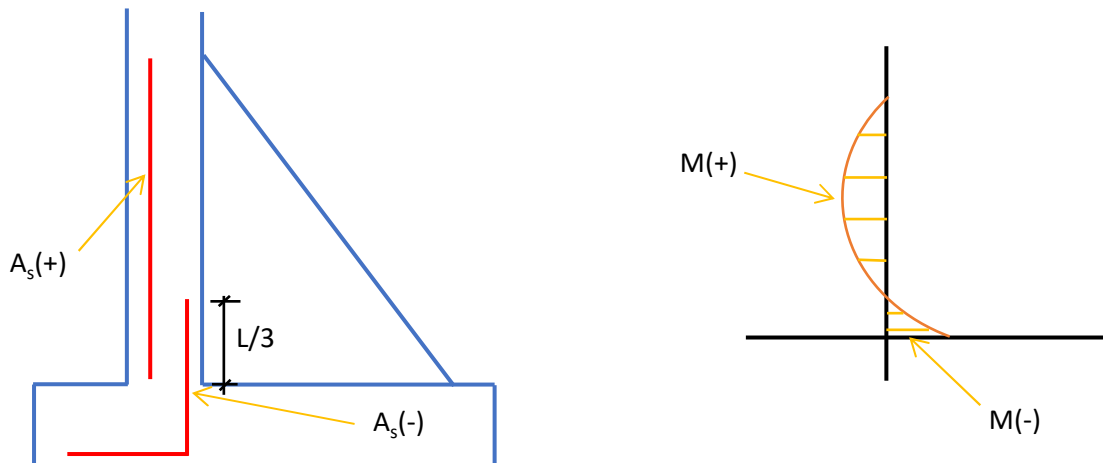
Refuerzo vertical para pantalla del estribo.
